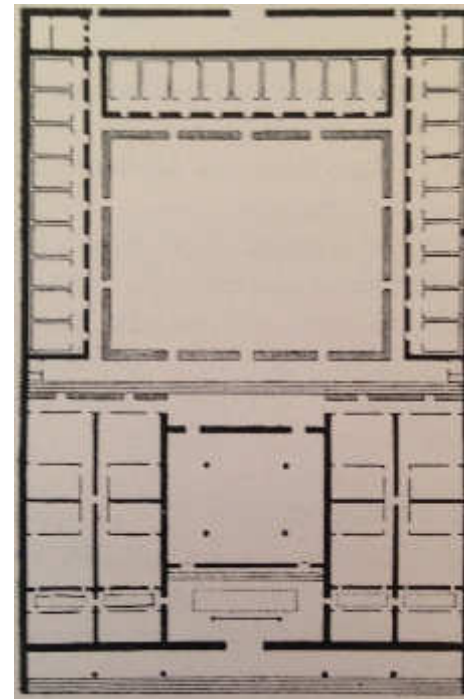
Grundriss eines chinesisches Kornhauses
